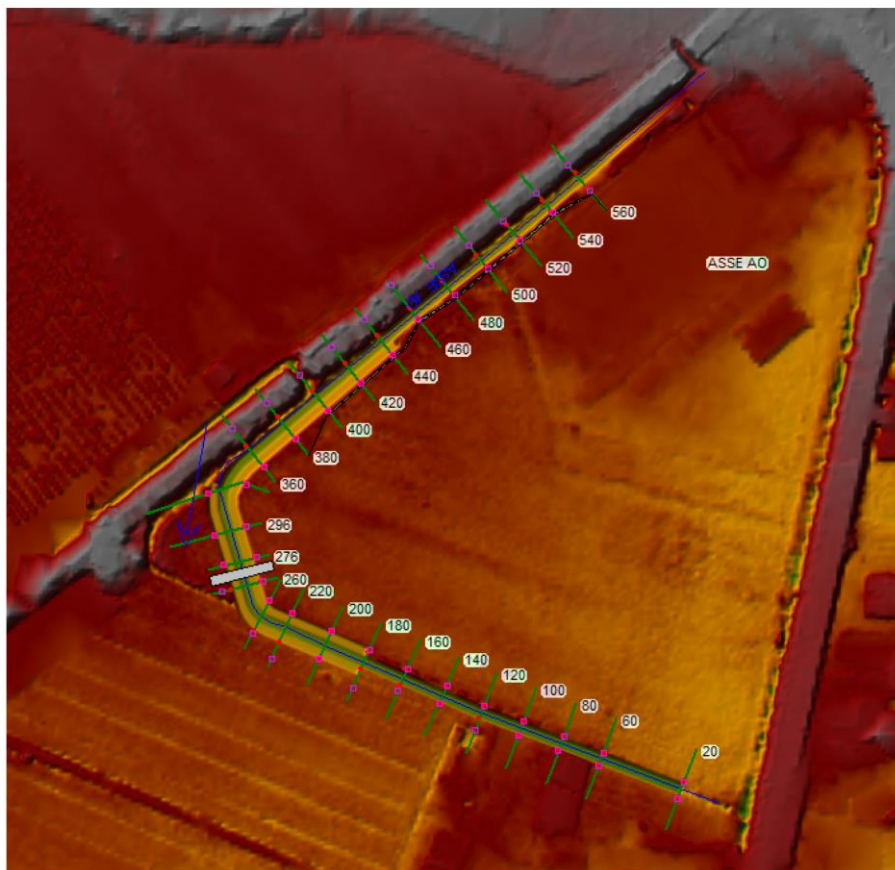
l'andamento planimetrico delle sezioni di calcolo nella configurazione post operam
